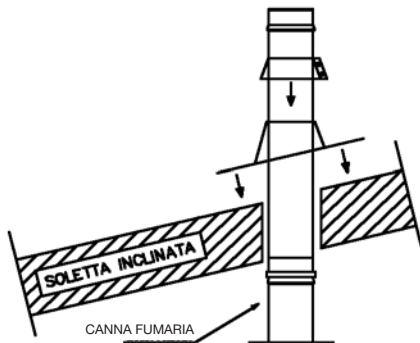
A Schema di montaggio del faldale inclinato con fascetta per faldale
